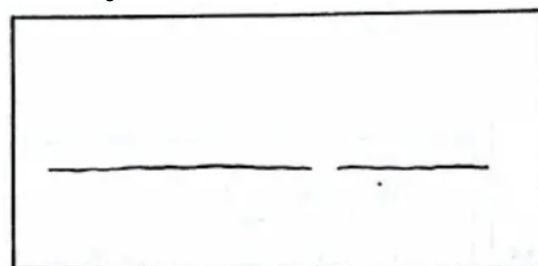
Já as aberturas horizontais, segundo o referido autor, são provenientes da ruptura gerada por compressão dos elementos de alvenaria ou do próprio revestimento argamassado, ou até mesmo solicitações de flexocompressão da parede Figura 13b.
